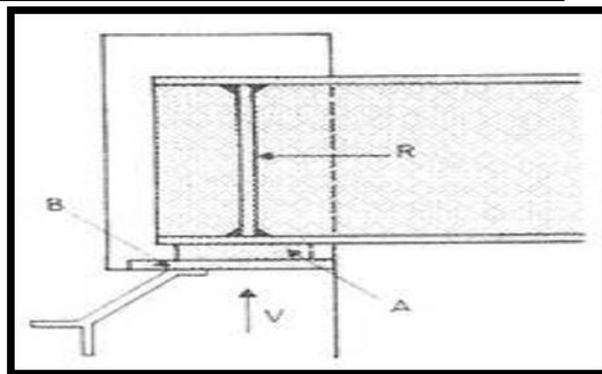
Appui simple de poutre sur un mur en voile en béton armé
